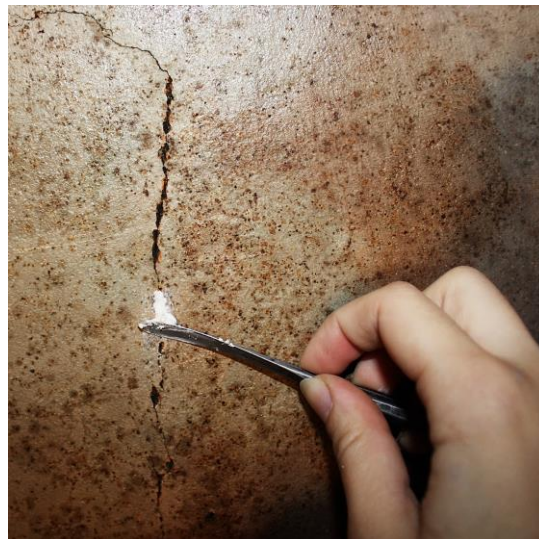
Aplicação de uma argamassa de cal e areia numa fissura.
